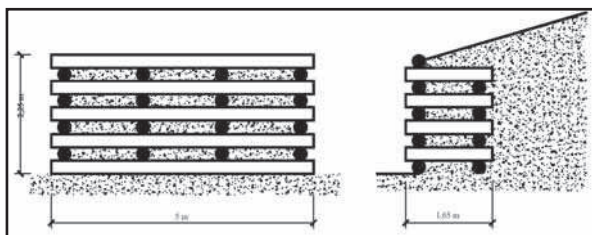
a: Prospetto e sezione della palificata dell'esempio
